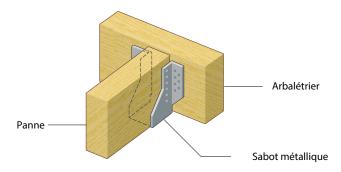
Exemple de fixation des pannes sur l'arbalétrier par des sabots métalliques
